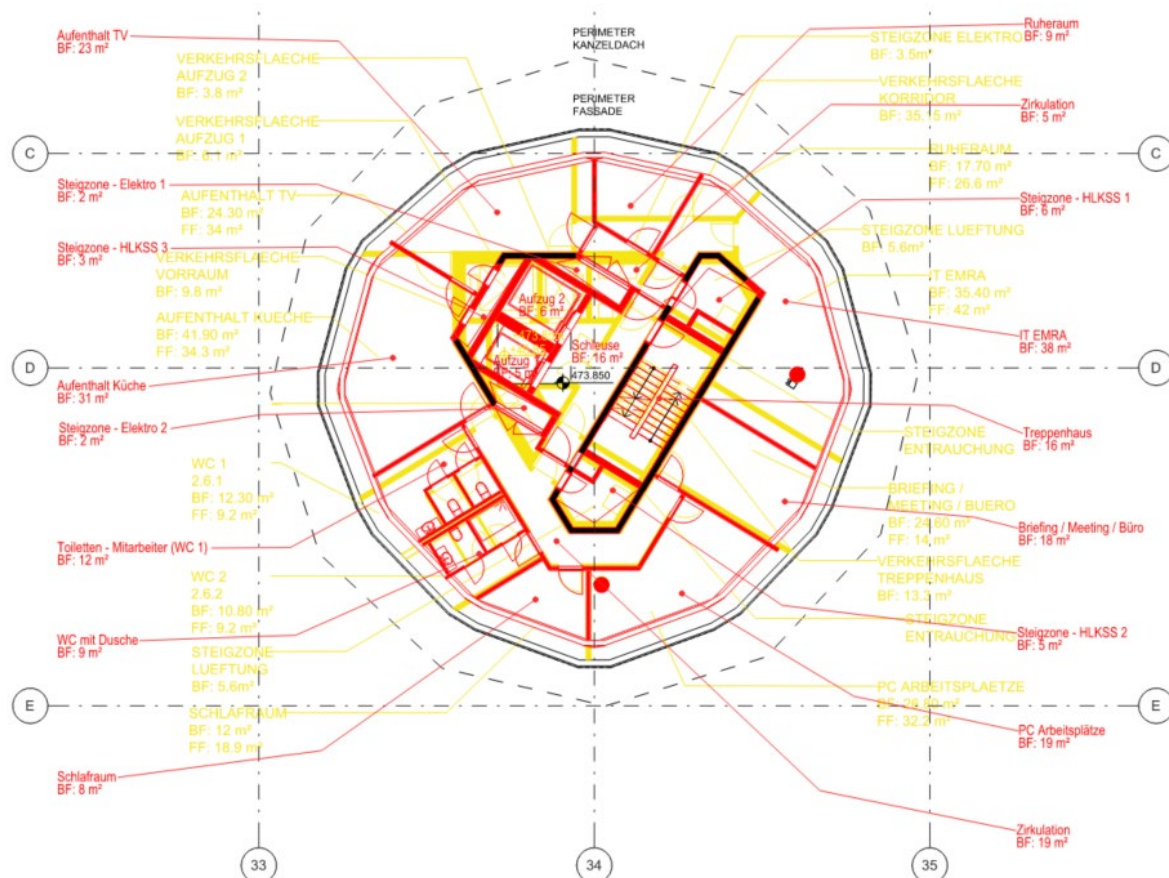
Grundriss Supportgeschoss G9
